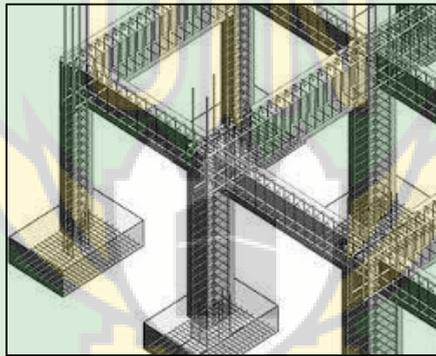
Ilustrasi Pondasi Foot Plat
